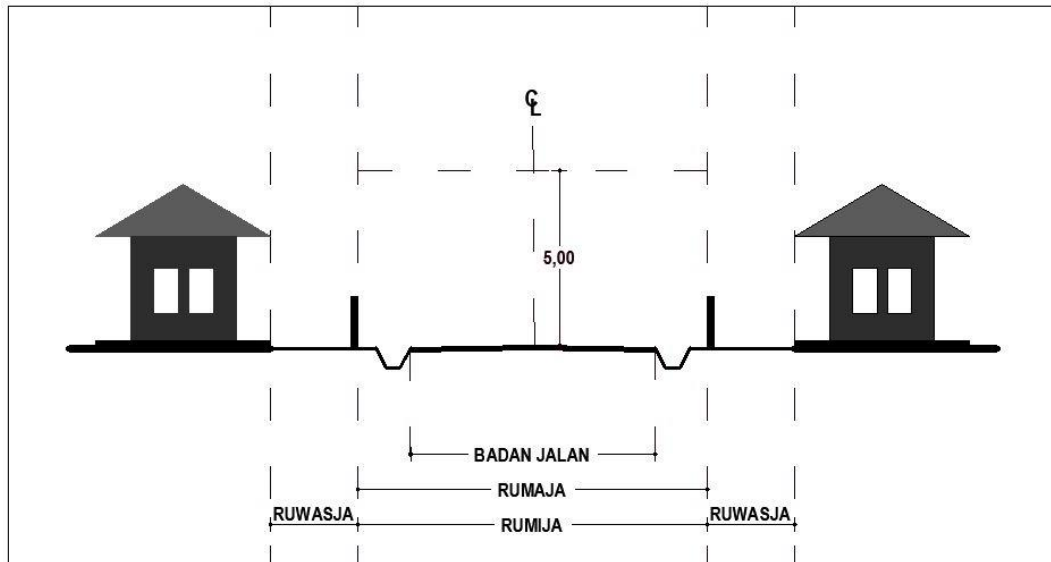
Contoh Penempatan Gapura di Ruang Milik Jalan Tipe 3
